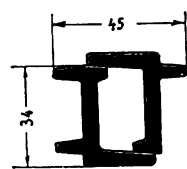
Stahlfensterprofil mit schrägen Abdichtflächen
